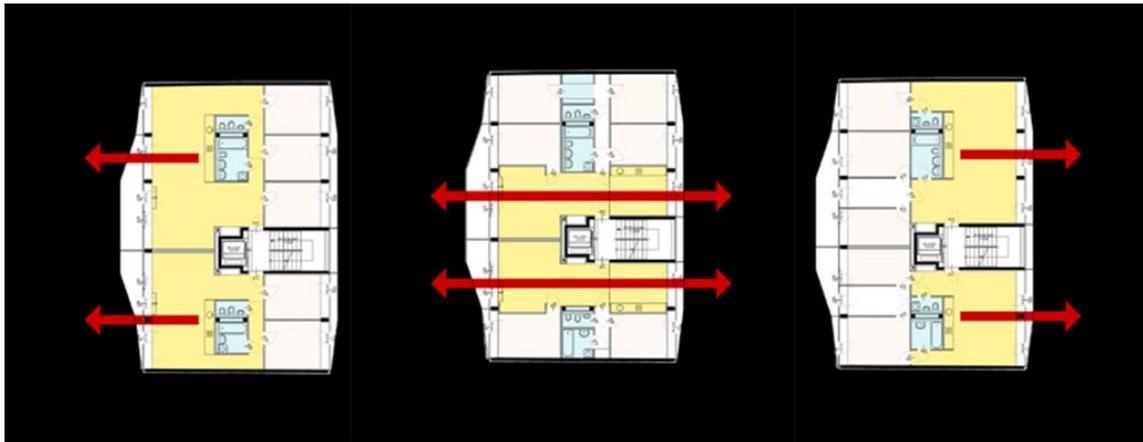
Flexible Grundrisse der Wohnungen im Wohnhaus LEE mit Hof-, Quer- oder Straßenorientierung (www.querkraft.at)
